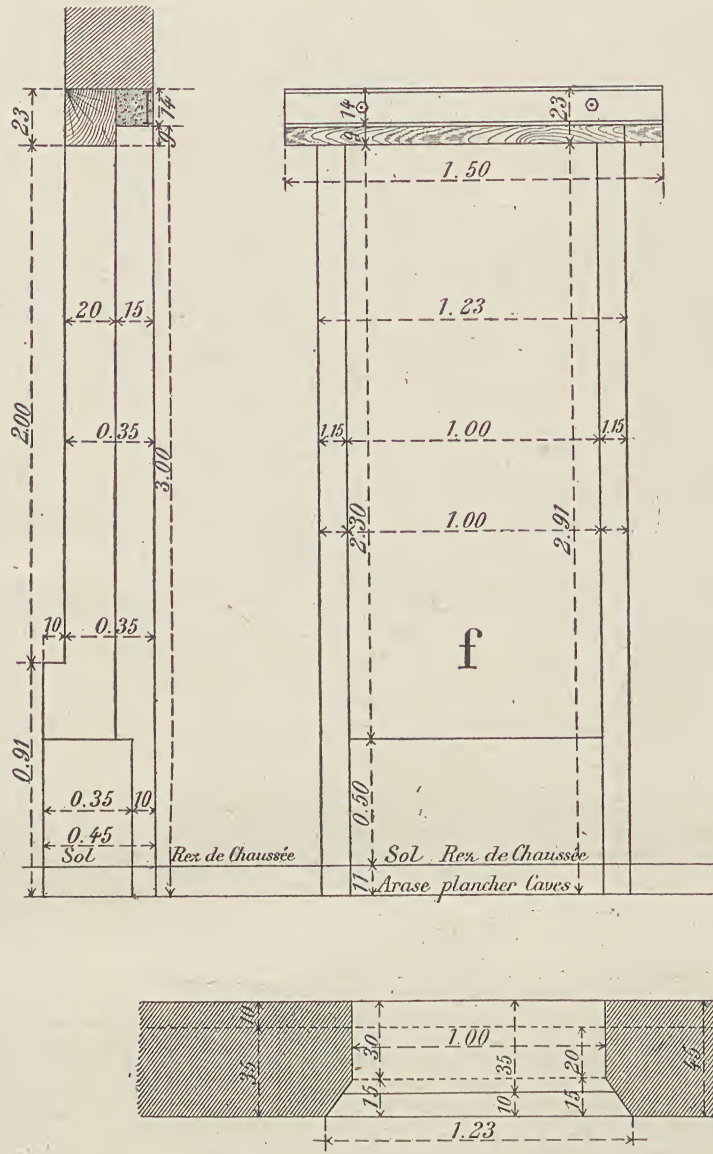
à 597. — Baie f. Coupe, élévation intérieure et plan.
